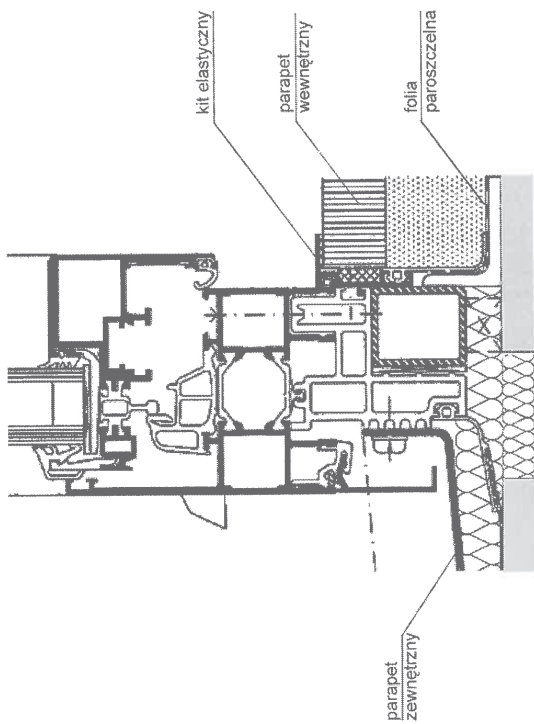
Przykłady zamocowania parapetu zewnętrznego w oknach drewnianych w różnych rodzajach ścian
